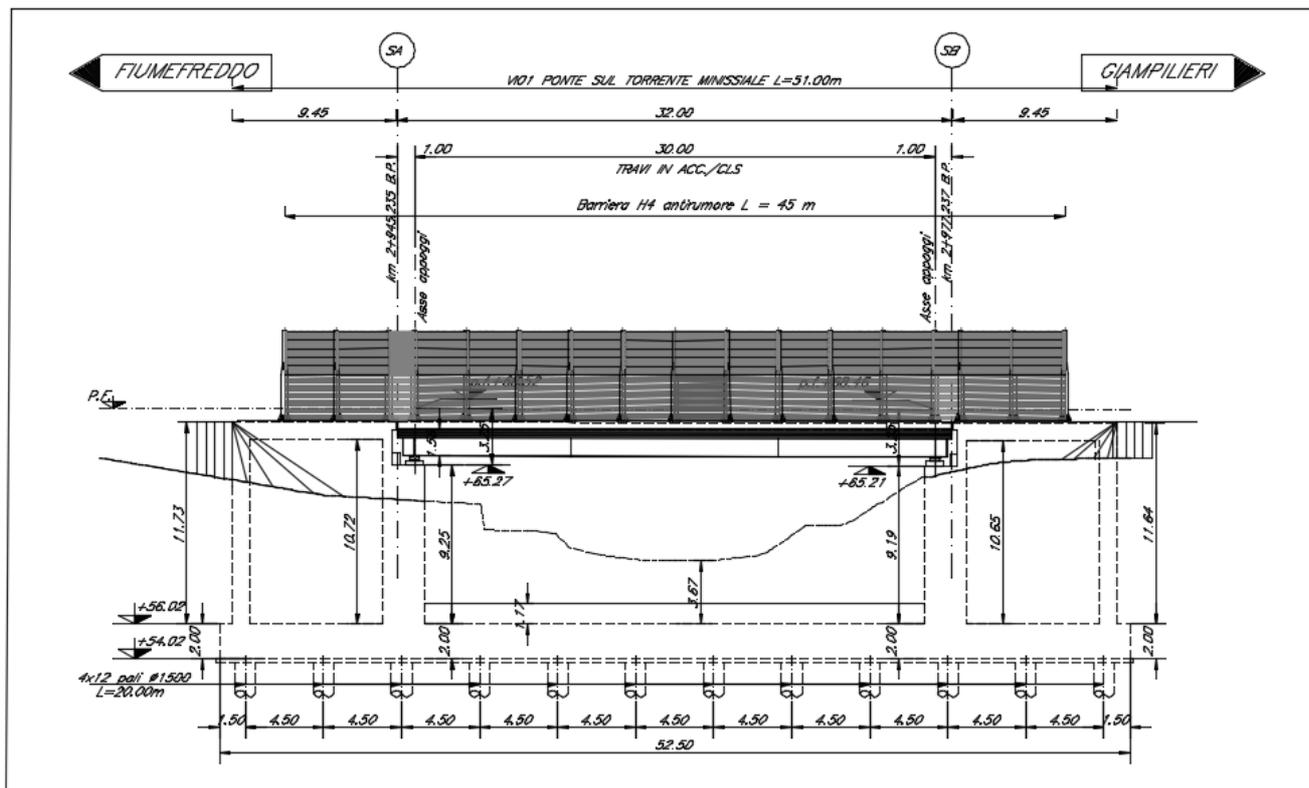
Ponte sul torrente Minissale: sezione trasversale e prospetto
